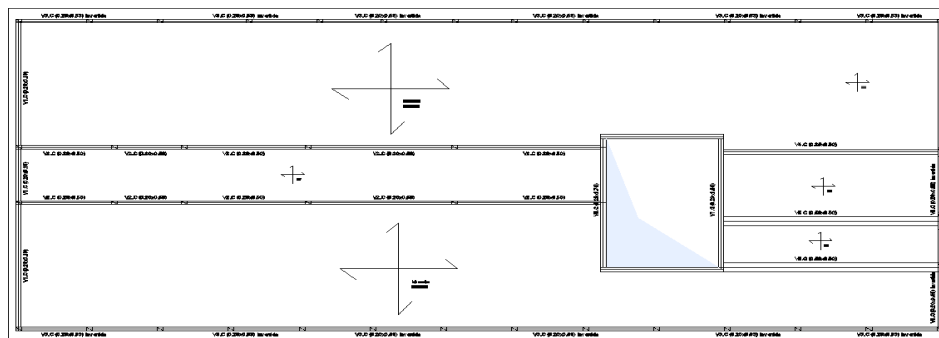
Planta estrutural de cobertura do módulo C (s/escala)
